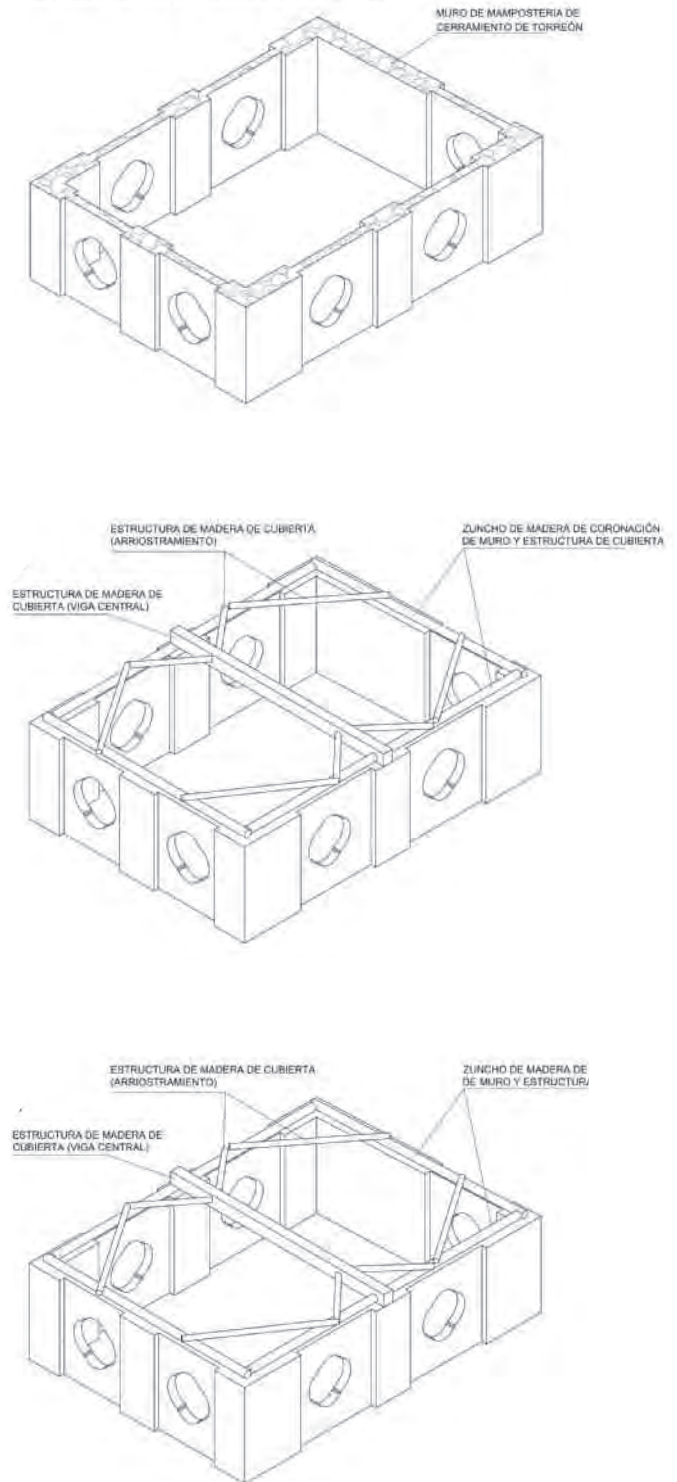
Detalles de la rehabilitación propuesta para la cubierta del pabellón.
